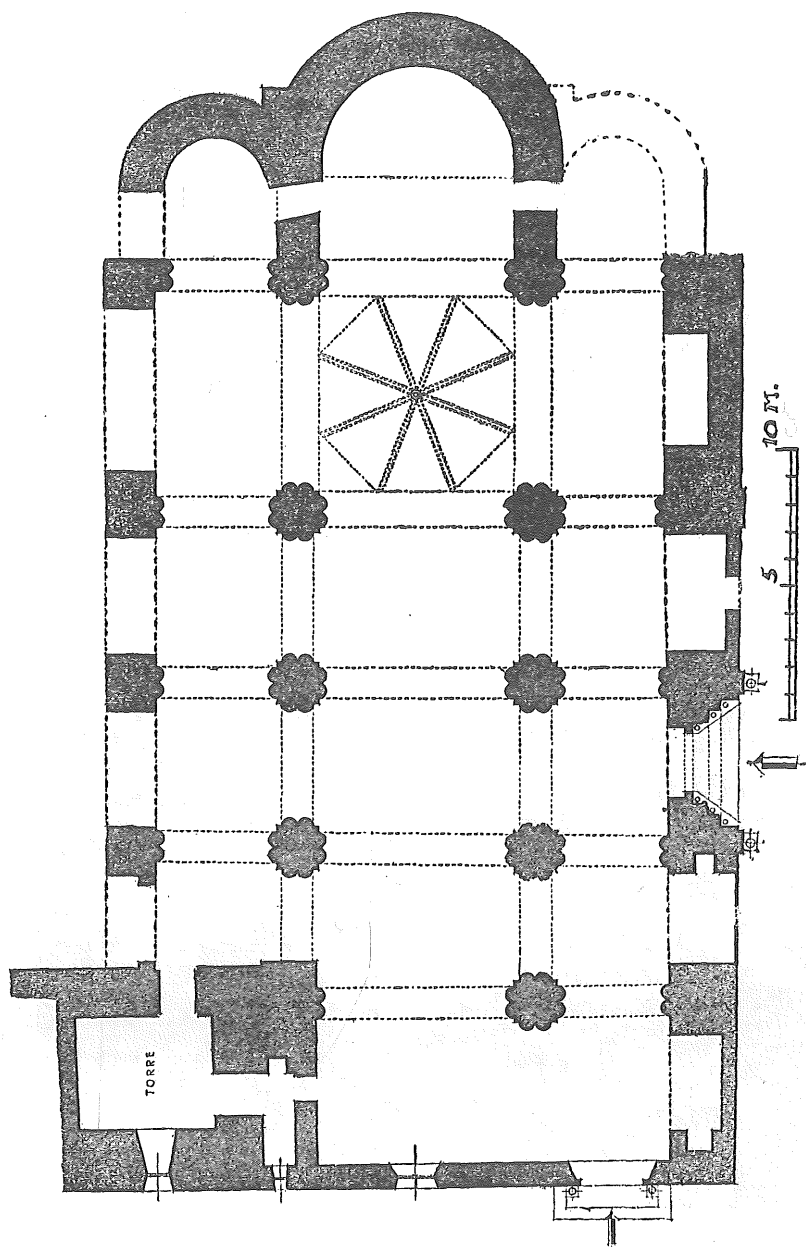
Tamarite de Litera (Huesca). Planta de la iglesia.
